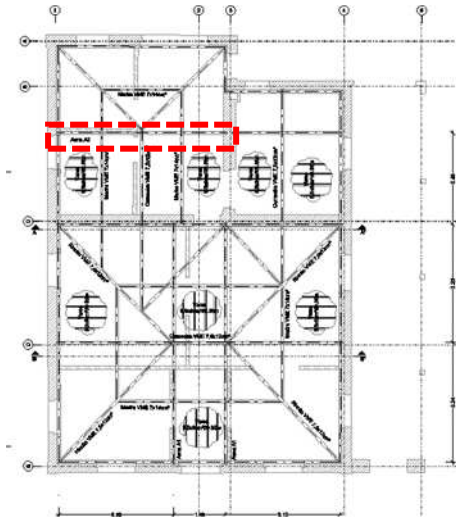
Estrutura em madeira da cobertura existente (asna A1)
